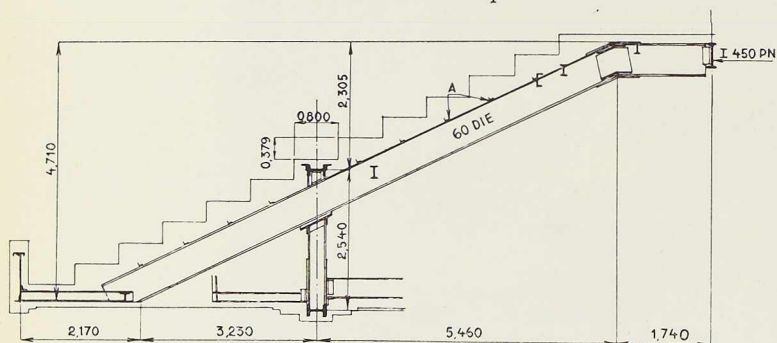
Vue d'une poutre de balcon portant les gradins.
